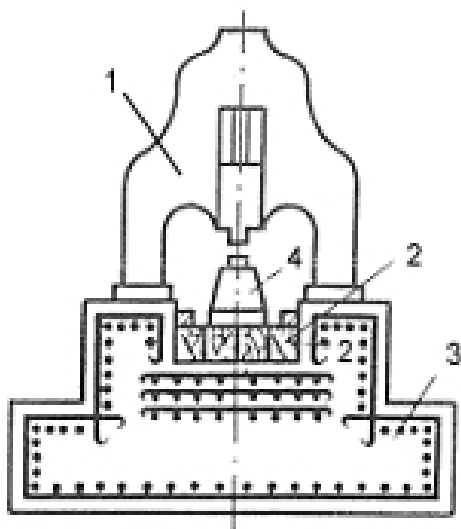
Схема массивного фундамента: 1 – станина; 2 – прокладка; 3 – фундамент; 4 – шабот
